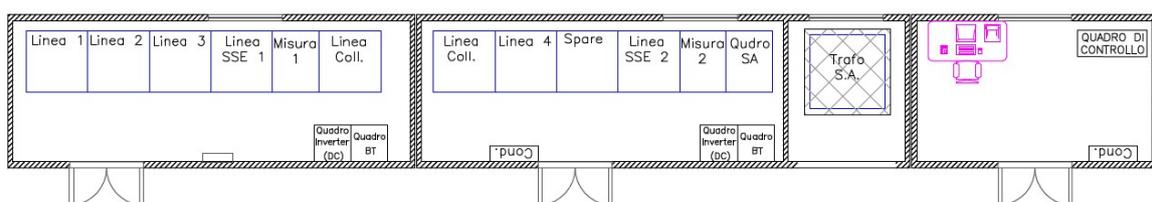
Quadro di Raccolta e Misura: Zona 1, Planimetria
